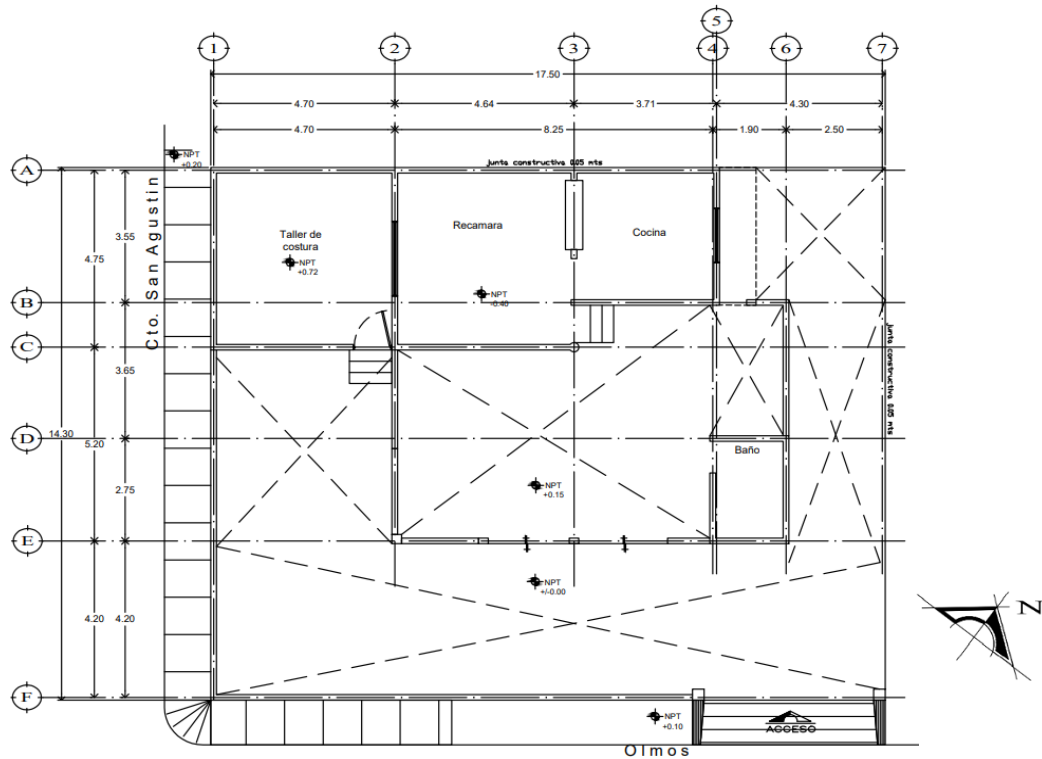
Levantamiento arquitectónico, caso Leticia Navarro Alfaro. Elaboración propia.
